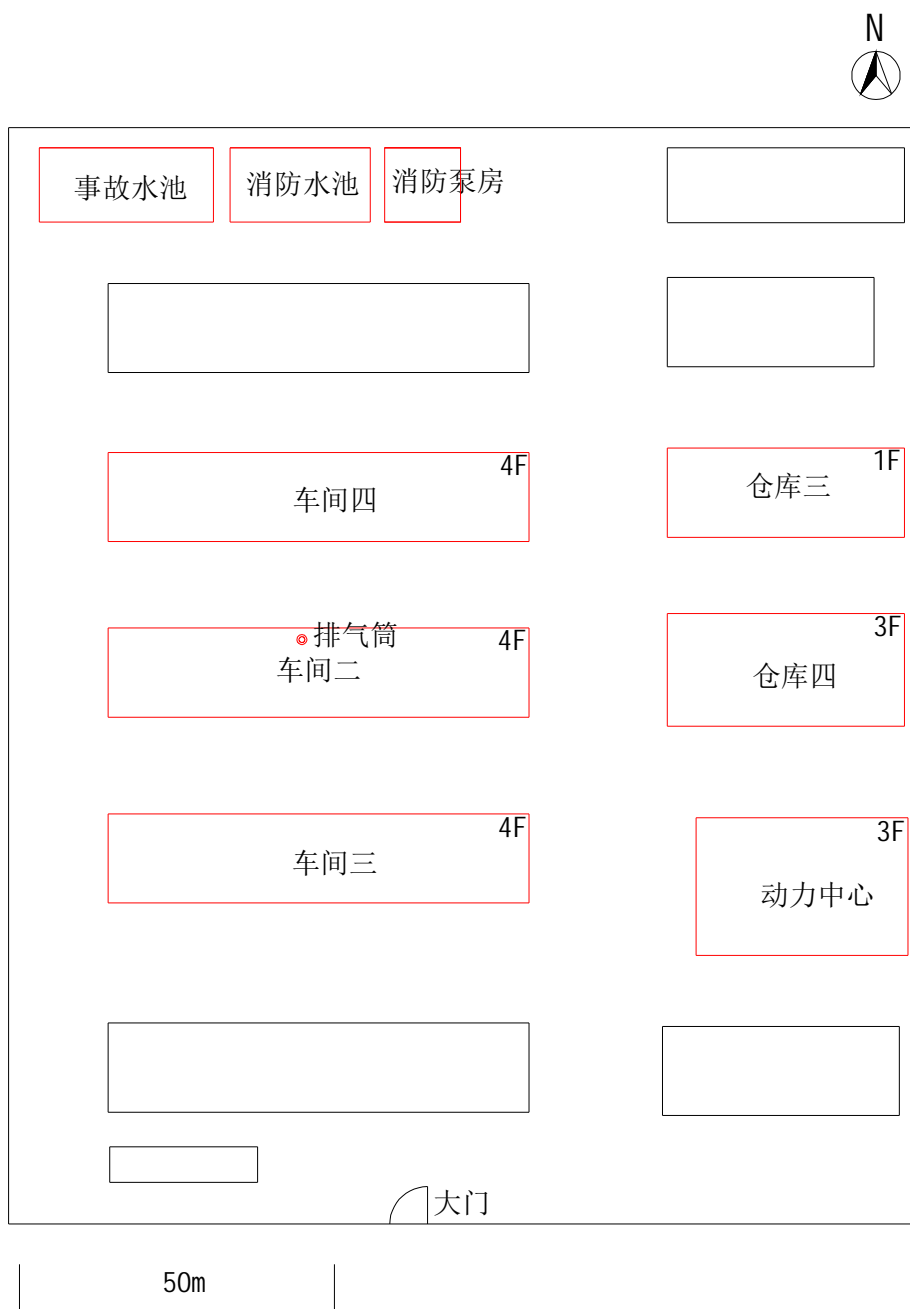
厂区总平面布置图 红色部分为本项目，危废库位于一期项目
